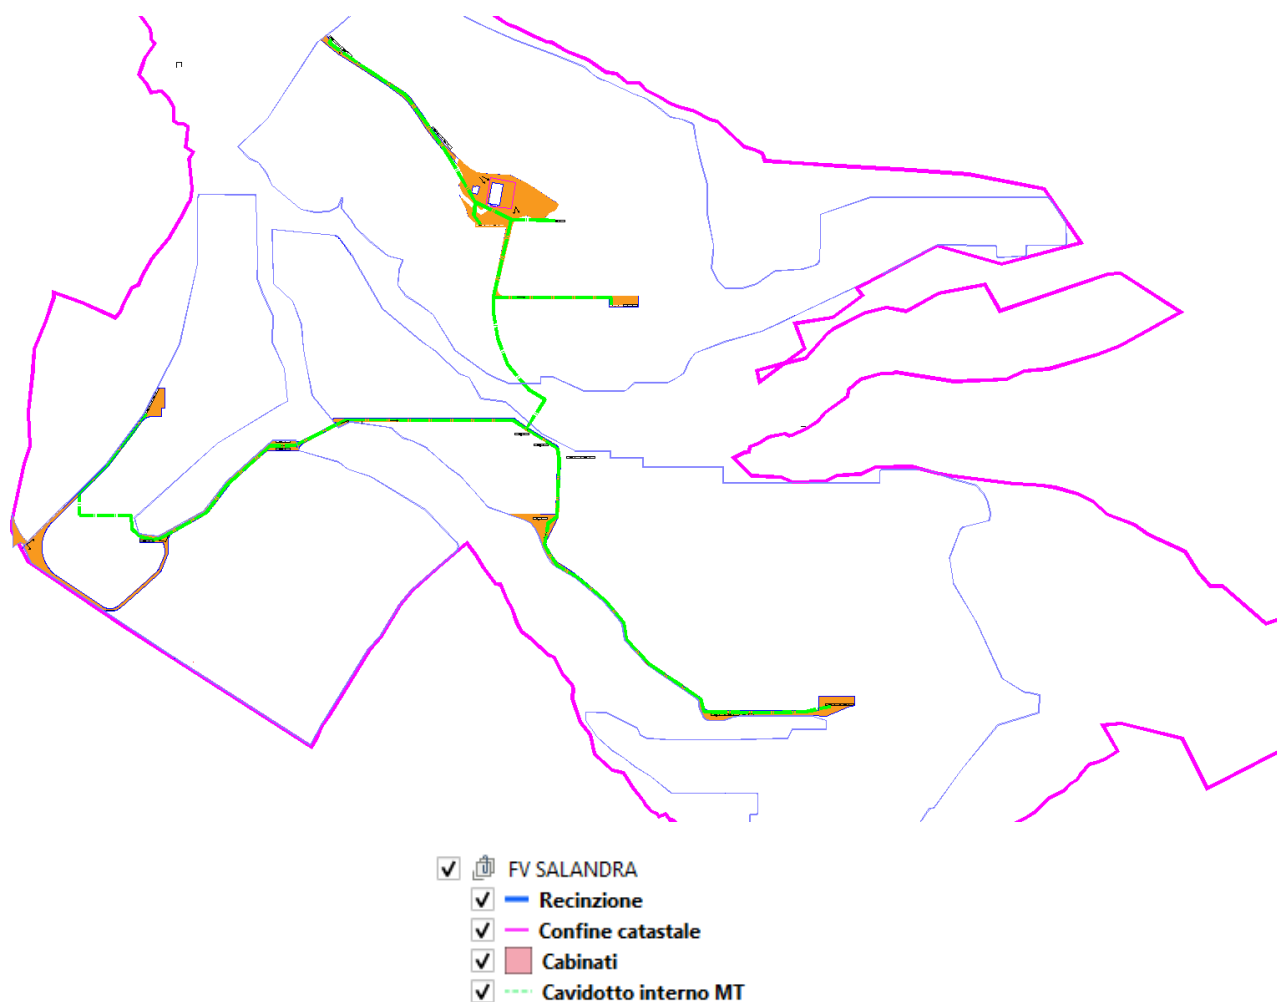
schema planimetrico collegamenti MT tra le cabine (elettrodotto MT interno)
